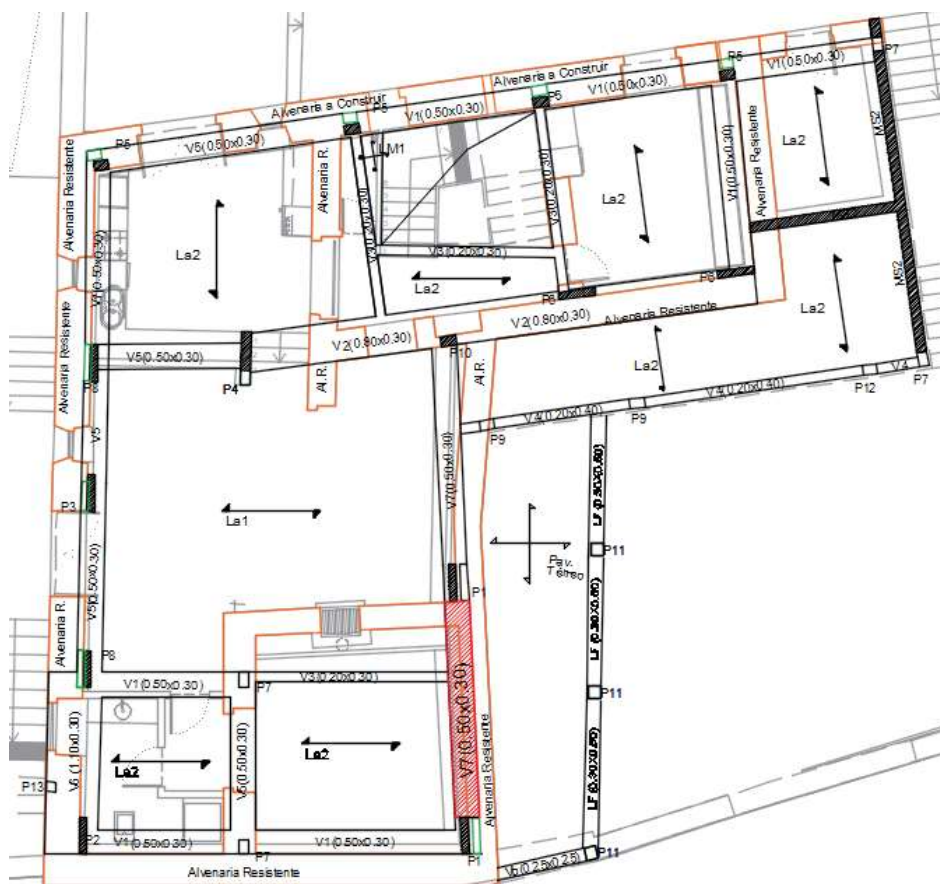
Planta estrutural do teto do cave, evidenciando a viga V7 em análise (sem escala).
